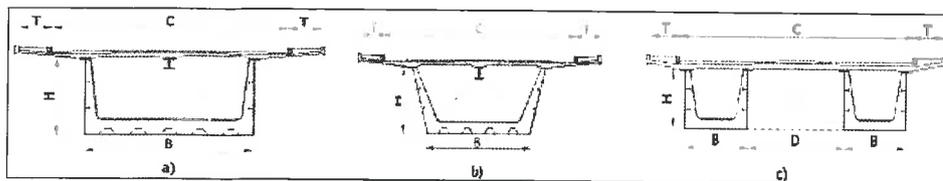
Tipuri de secțiuni transversale ale structurilor mixte cu conlucrare continuă
